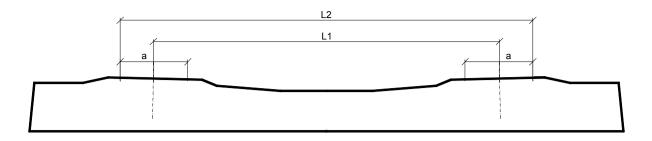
Железобетонная шпала со скреплениями Pandrol, SB-3
